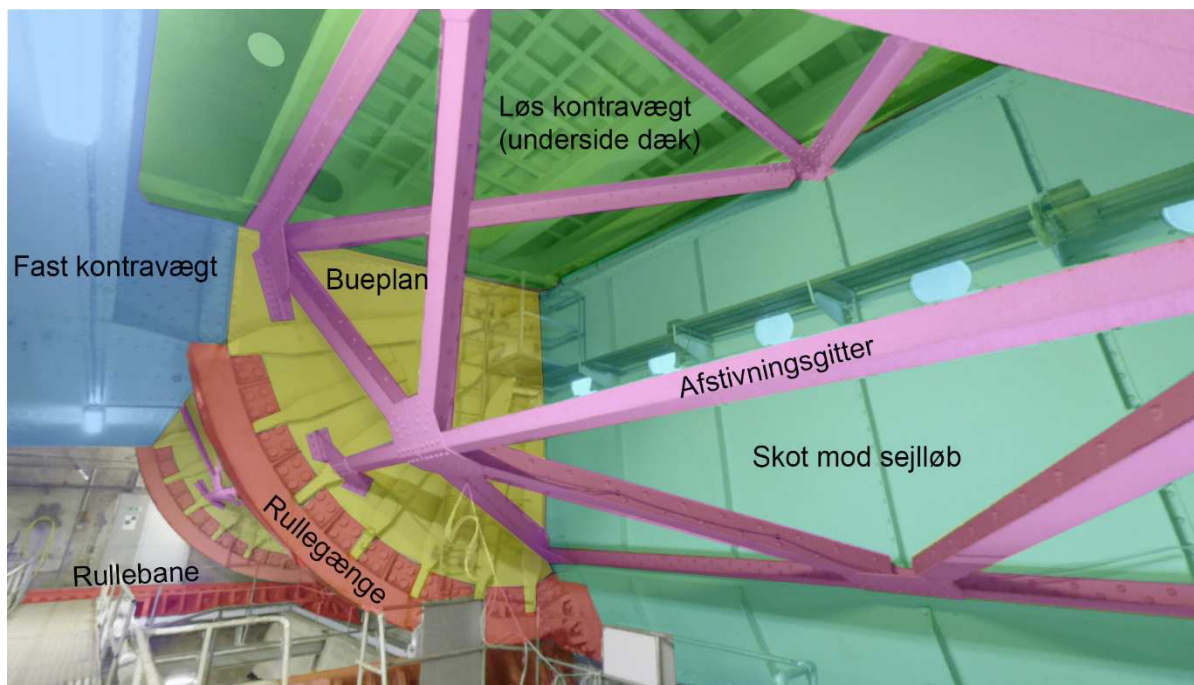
Åbning begyndt. Den del af klappens kørebane der udgøres af den løse kontravægt, er markeret med grønt. Foto.
